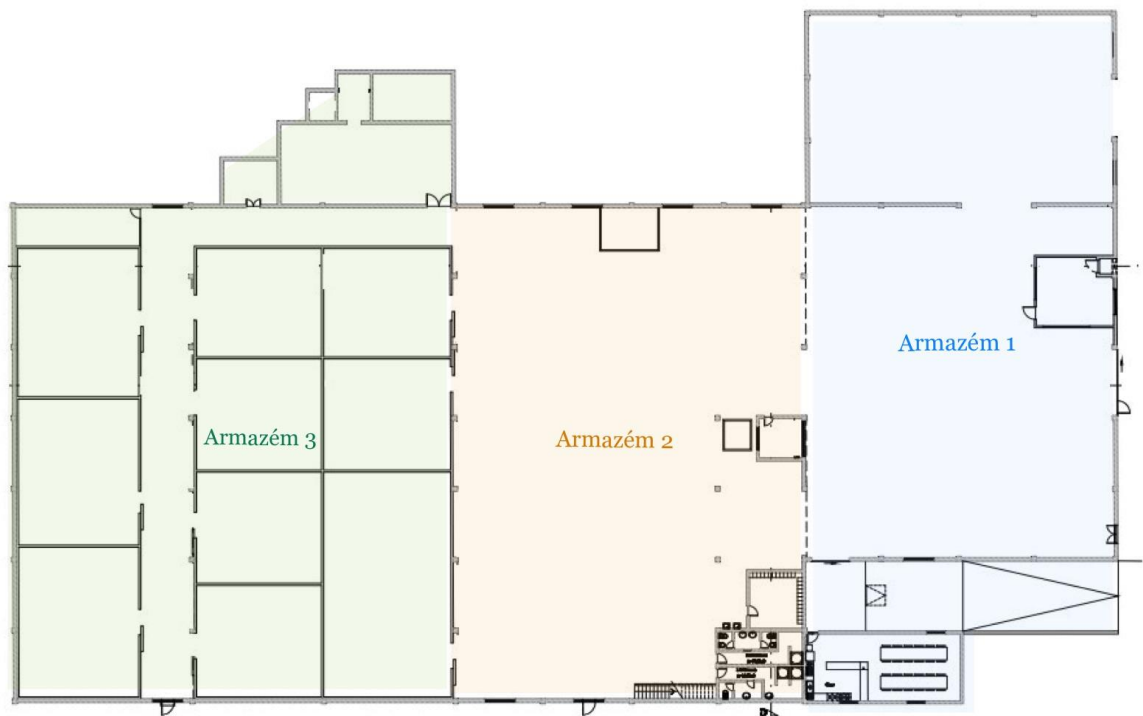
Planta das instalações (Armazém 1,2 e 3).
